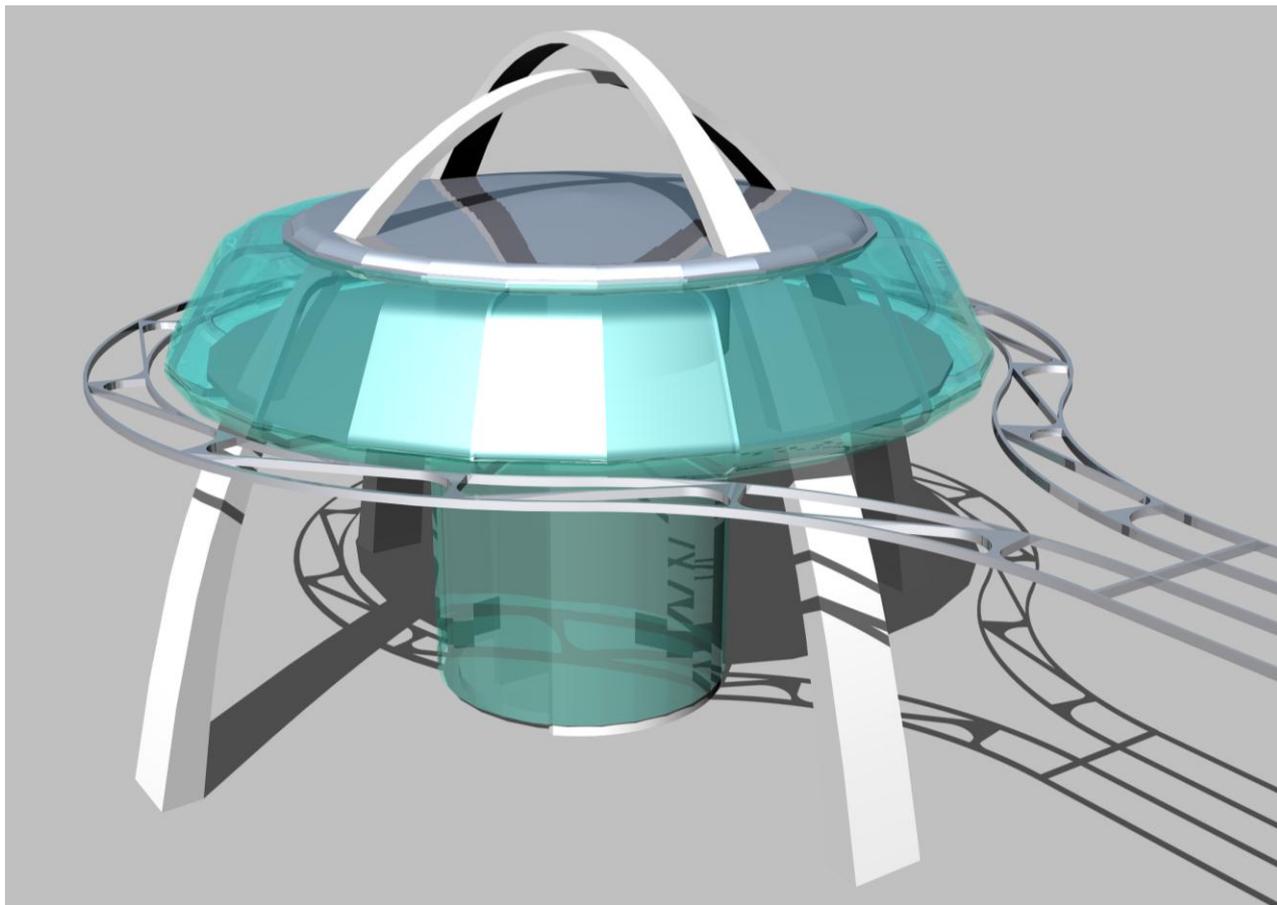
Разворотная станция двухпутного бирельсового СТЮ (вид сбоку)
